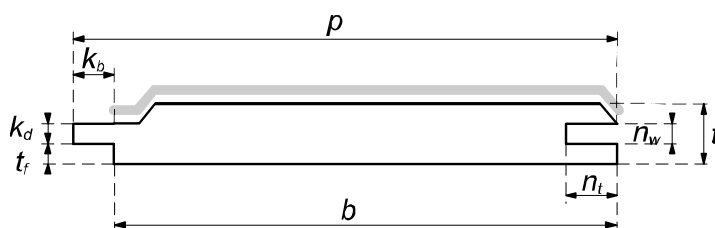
Section d'une planche profilée rainée-crêtée (schématique)
